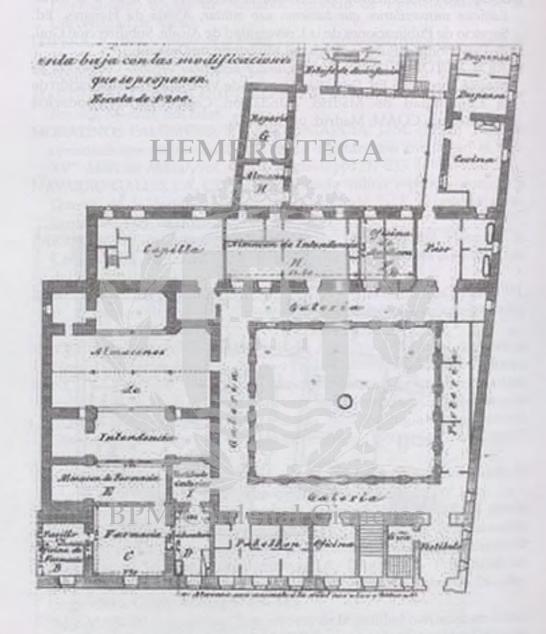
Planta baja H. militar. 1918. La farmacia se traslada. A.G.M.A.
